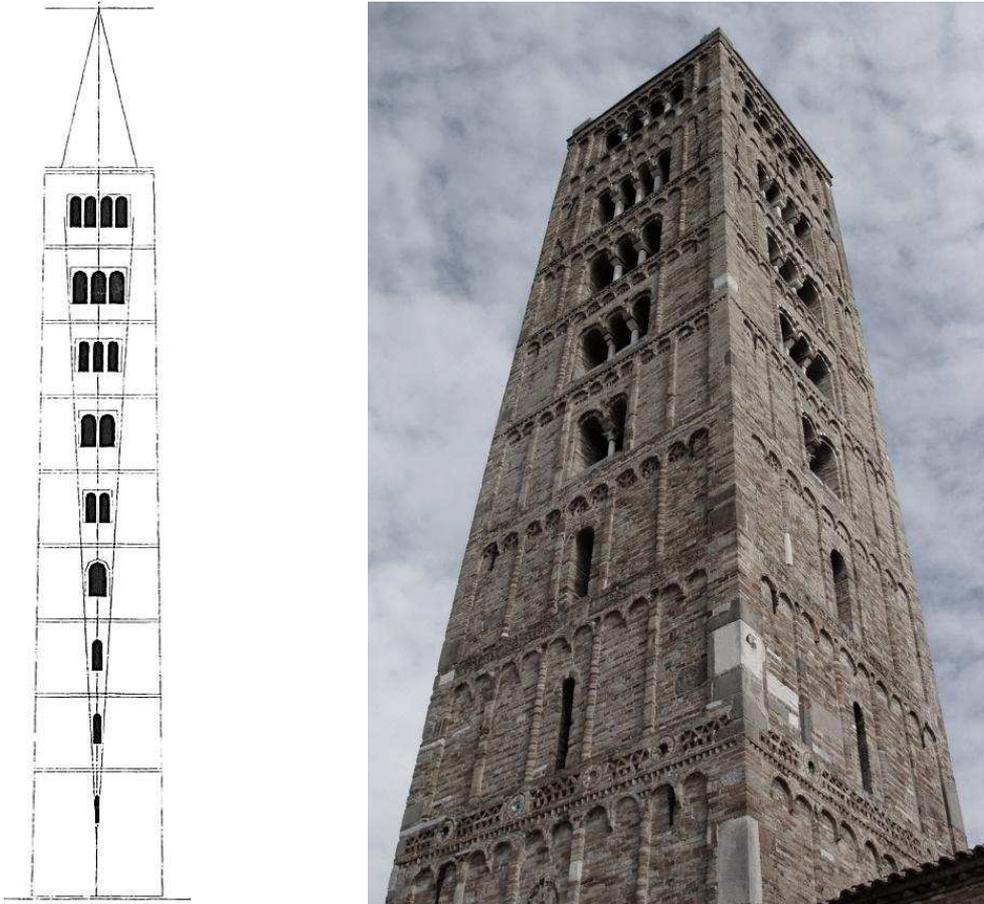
Alzado y vista de la Torre de la Abadía de Pomposa en Bologna. (Imágenes tomadas de [Cobrerros Vime 2002, 8] y propia, 2011).
